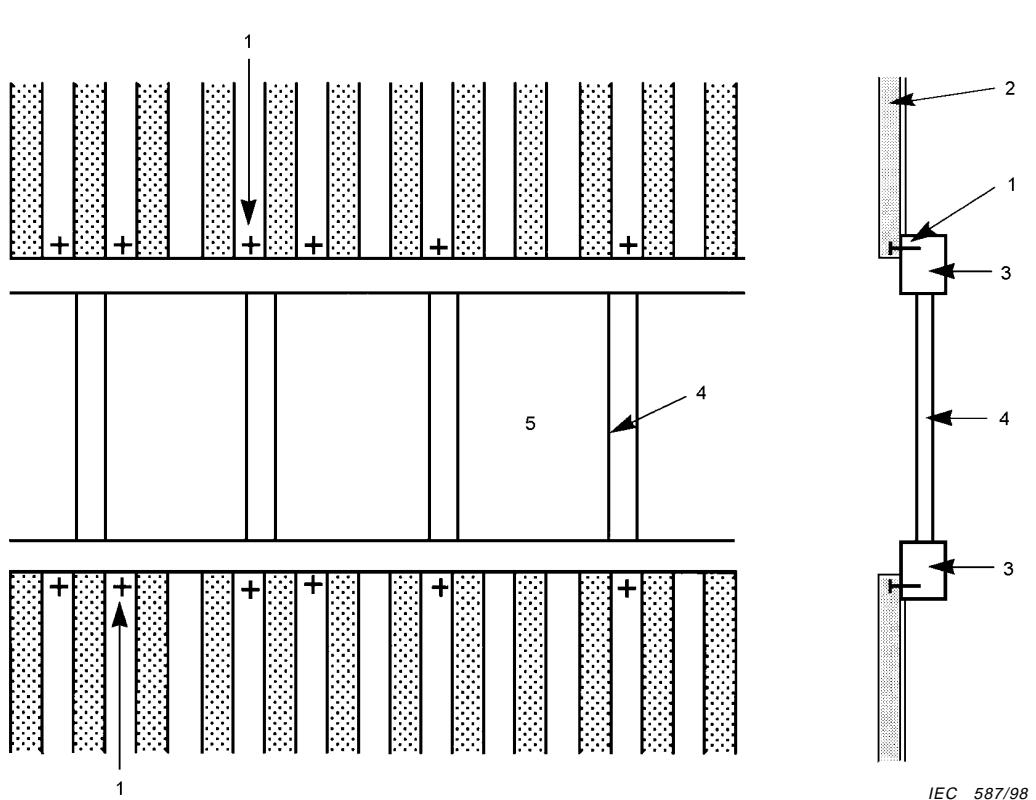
Connexion du bandeau continu de baies vitrées à un revêtement métallique de façade
